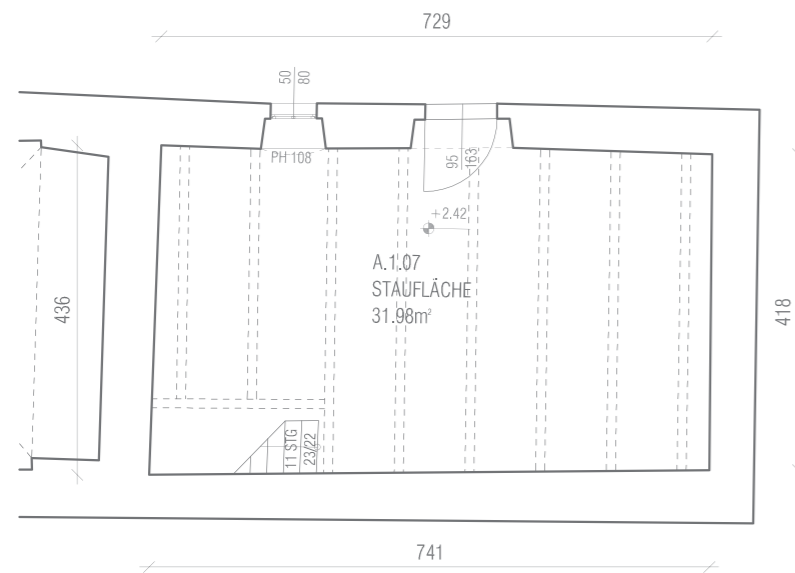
Grundriss Raum A.1.07_1:100
